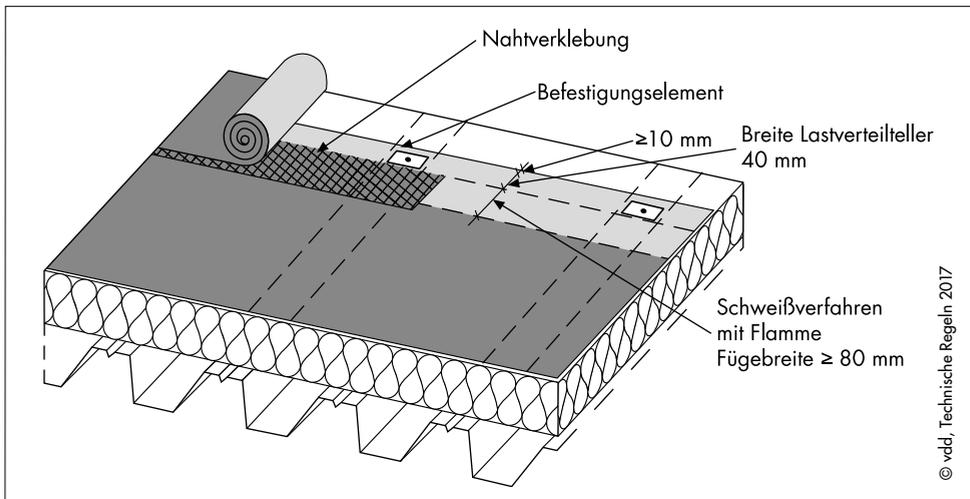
Mechanische Befestigung der einlagigen Abdichtung mit Elementen
